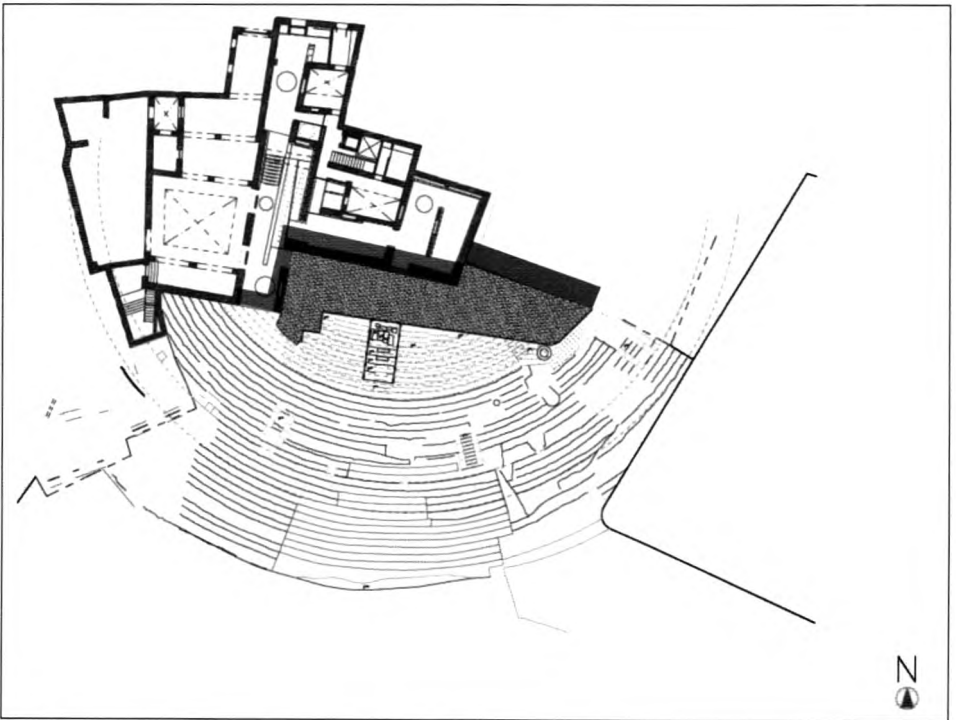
Plano con la zona máxima que teóricamente podrá ser excavada «en galería», bajo los edificios previamente al 2012
